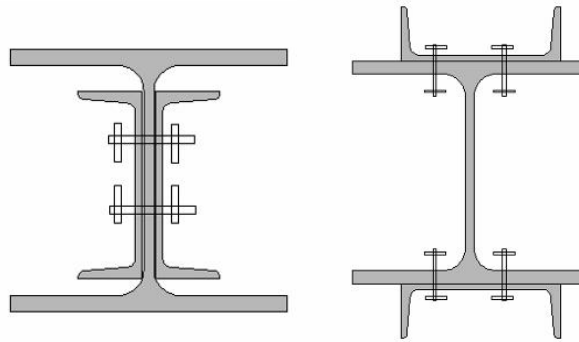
Consolidación de pilar mediante estructura metálica
